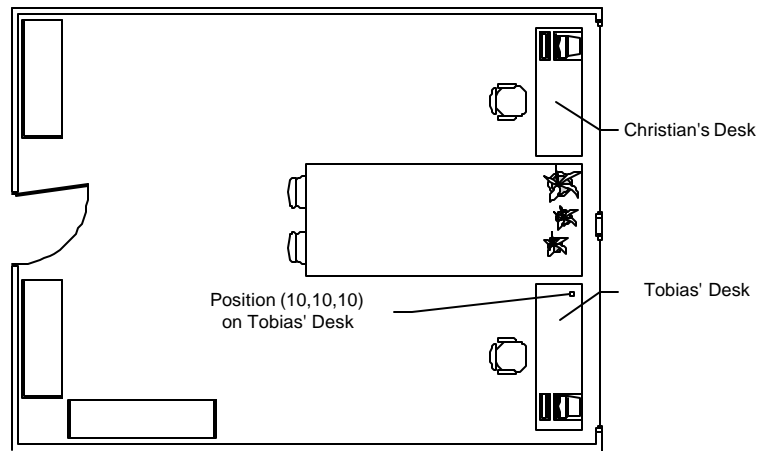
Grundriß eines Büroraums im TecO (RE.13)
